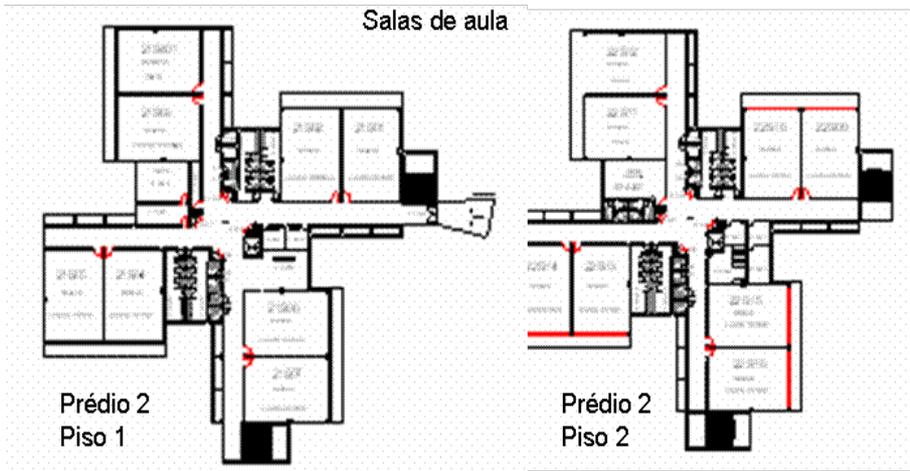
Planta dos pisos 1º e 2º do Prédio 2
